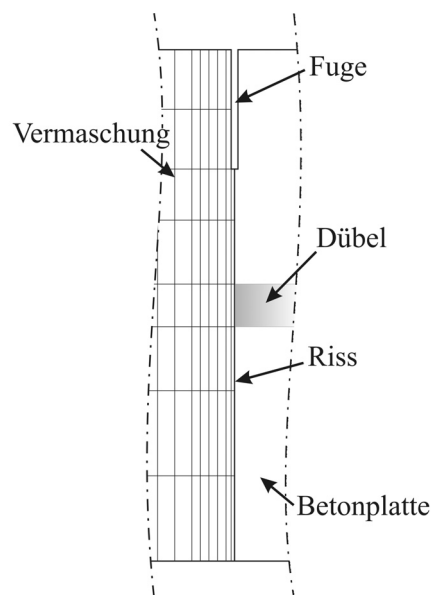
Detail der Fugenausbildung; links: Vermaschung, rechts: Betonplatte und Dübellage
